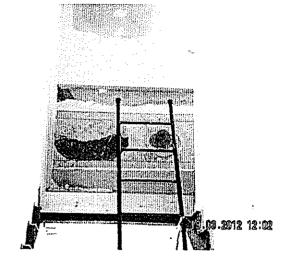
Primo piano: Scala accesso secondo piano (soffitta)
